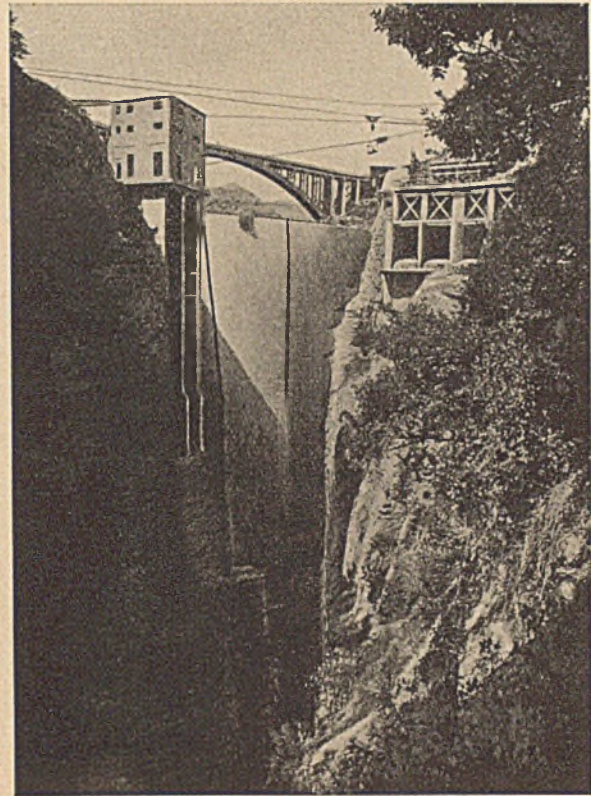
Sautée-Staumauer mit Hochwassereinläufen und Einlaßbauwerk.
